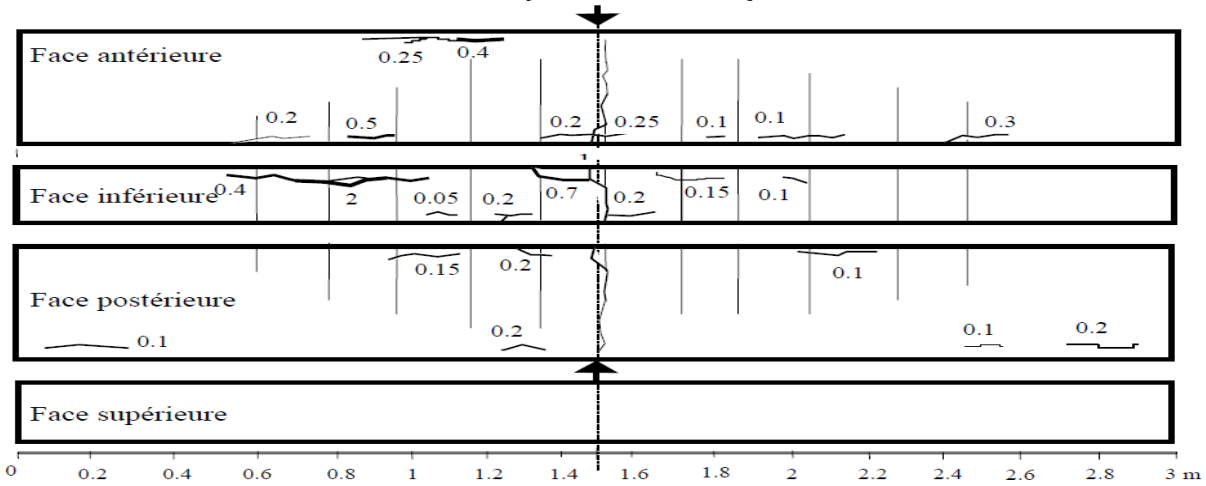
Carte de fissuration de la poutre B2CL1 (ouverture des fissures en mm) après 14 ans (Vidal et al. 2007).
